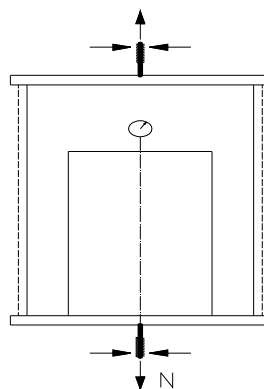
Схема установки для испытания на вытягивание арматурных стержней из бетонных цилиндров
